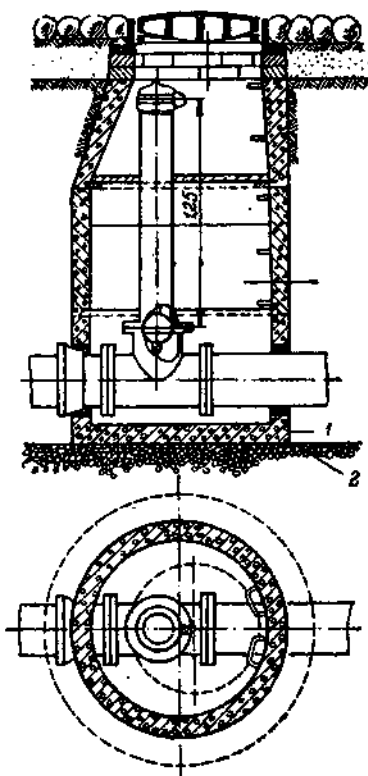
Установка пожарного гидранта в железобетонном колодце
